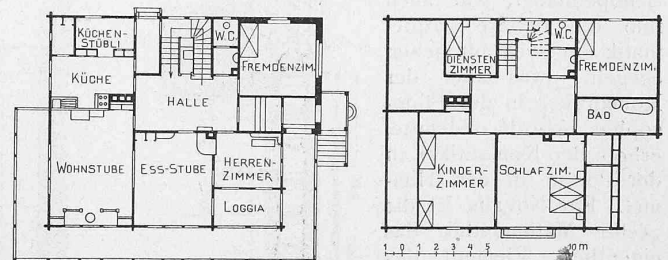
Grundrisse vom Erdgeschoss und Dachstock. — 1:400.
